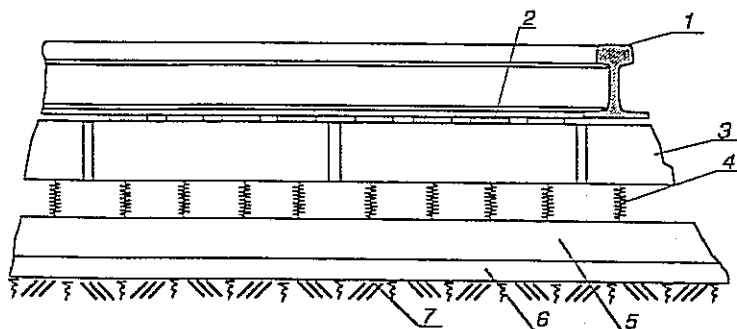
б - 1 -рельс; 2 - непрерывные упругие подкладки (слой); 3 - подрельсовая конструкция - непрерывная балка; 4 - упругое опирание; 5 - основная несущая конструкция; 6 - усиленное основание; 7 - земляное полотно.
